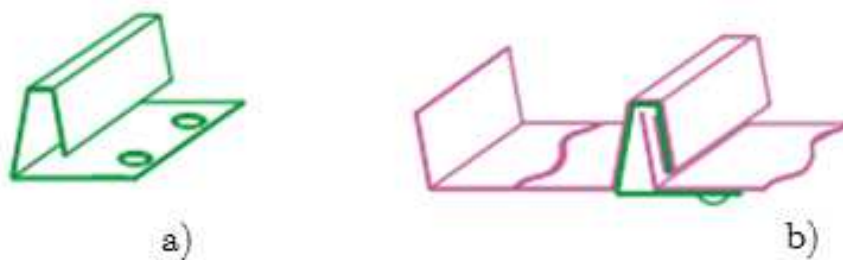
Presilha de fixação e pormenor de fixação [6]
